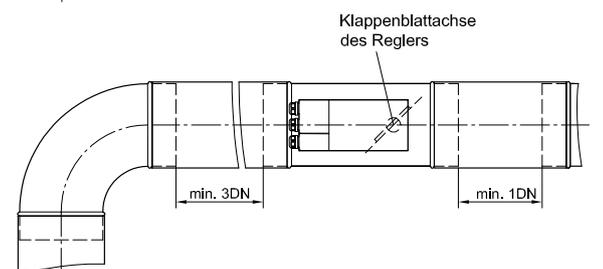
Einbau nach Störstelle, z.B. Bogen
